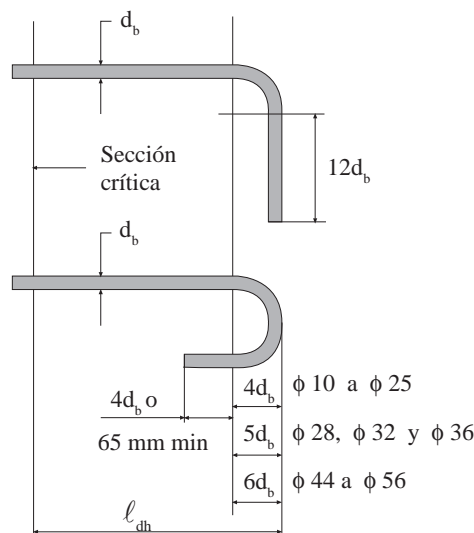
Detalles de barras dobladas para desarrollar el gancho estándar.
